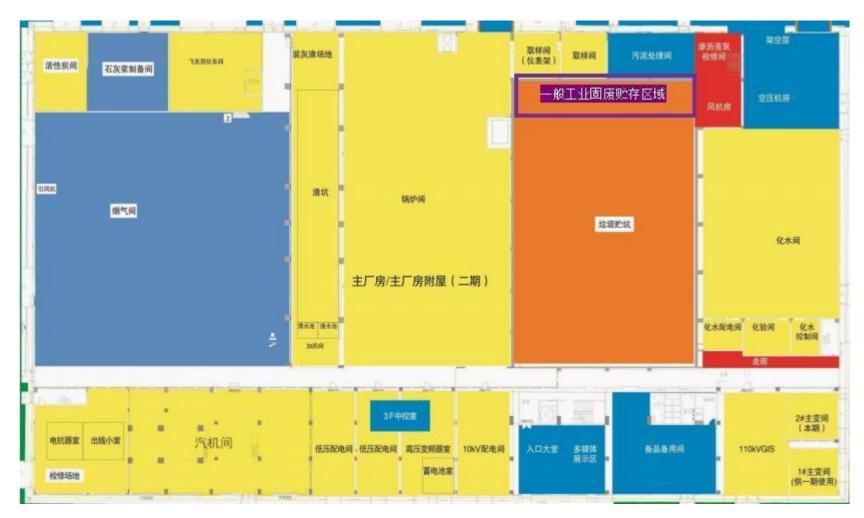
主厂房平面布置图(技改项目依托二期项目)
